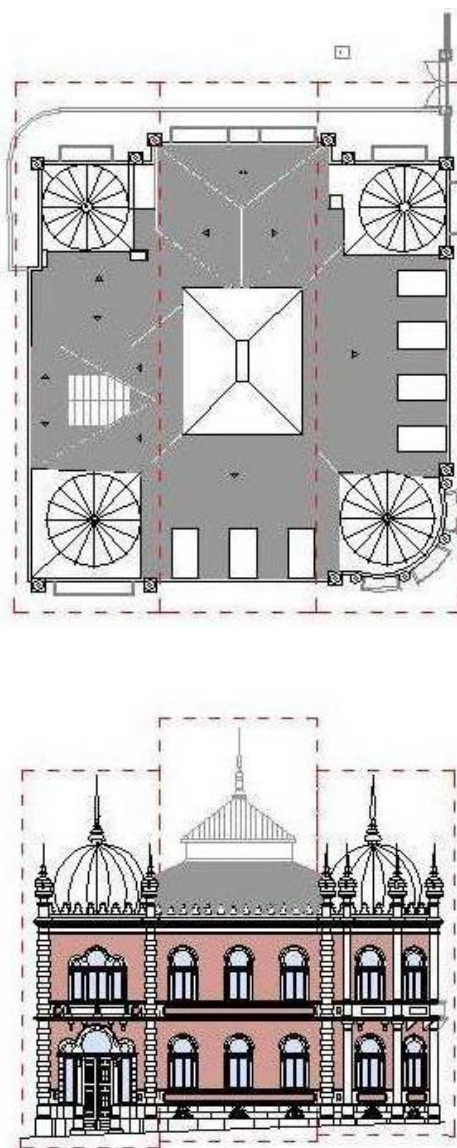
Palacete Ribeiro da Cunha-Planta de Cobertura e Alçado Principal
